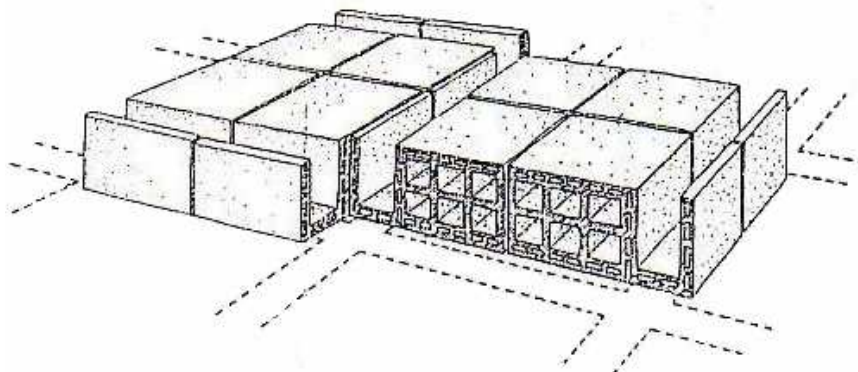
Forjado reticular con bloques aligerantes de tipo cerámico
